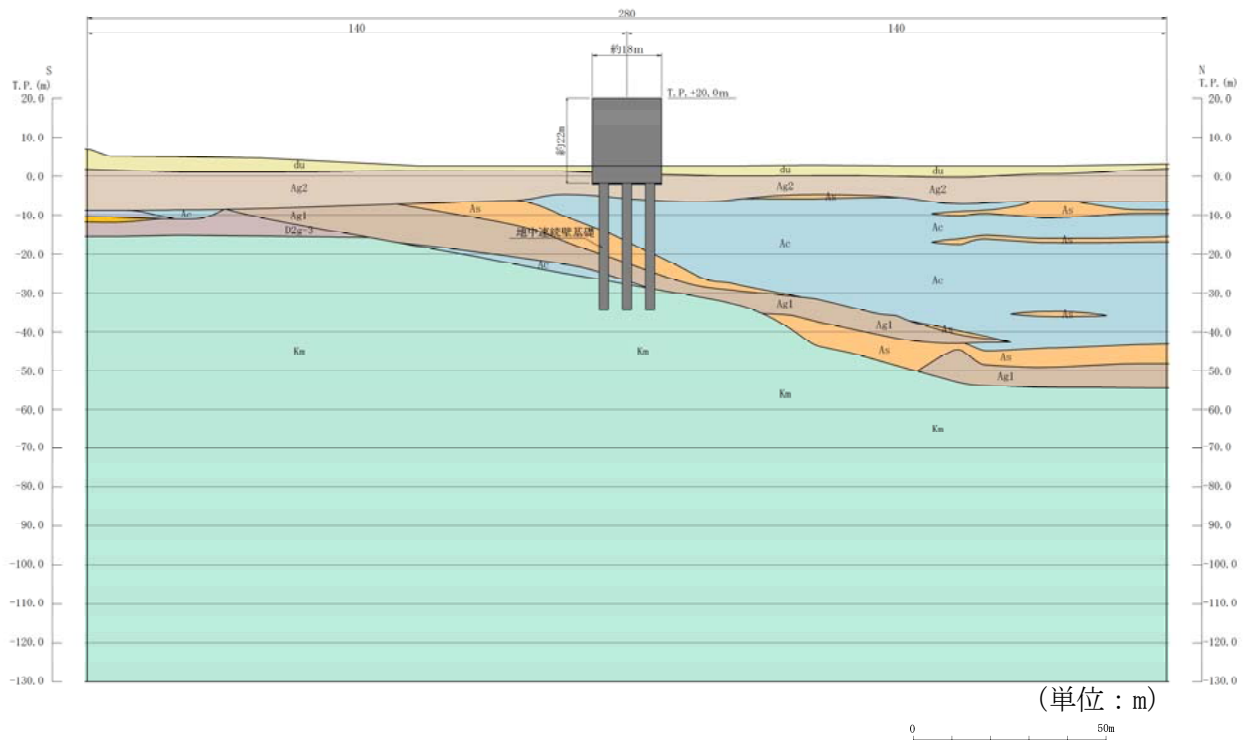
(3) 鉄筋コンクリート防潮壁 断面図(C-C断面)
